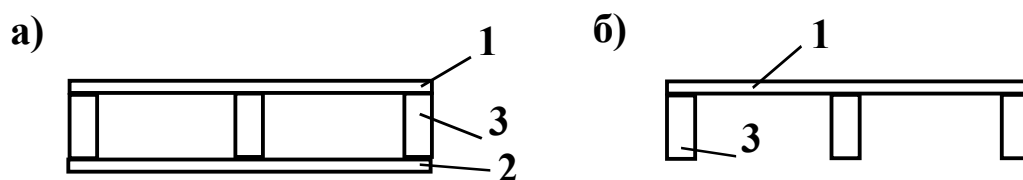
Поперечное сечение клефанерных утепленных (а) и холодных (б) плит
